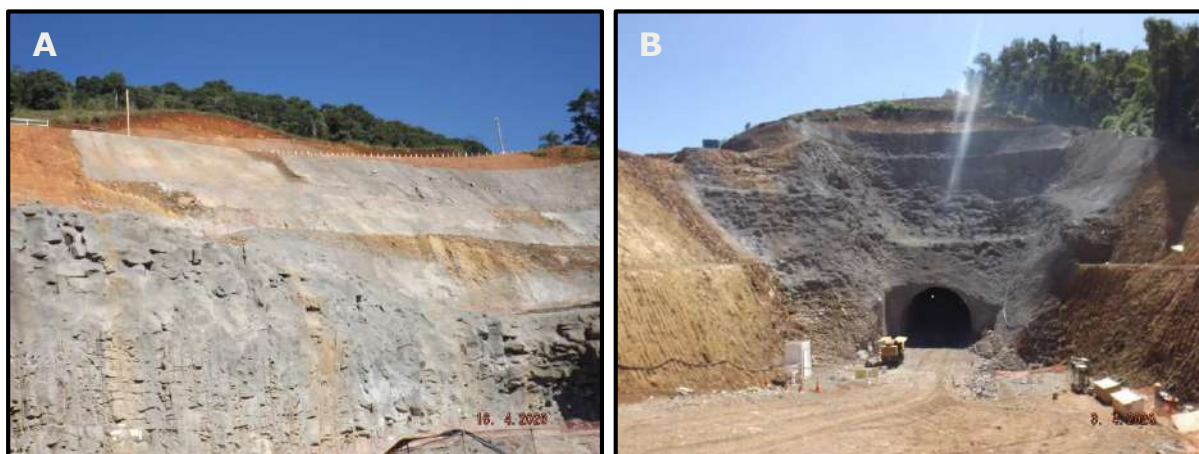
Proteção de taludes em frentes de obra com concreto projetado.
